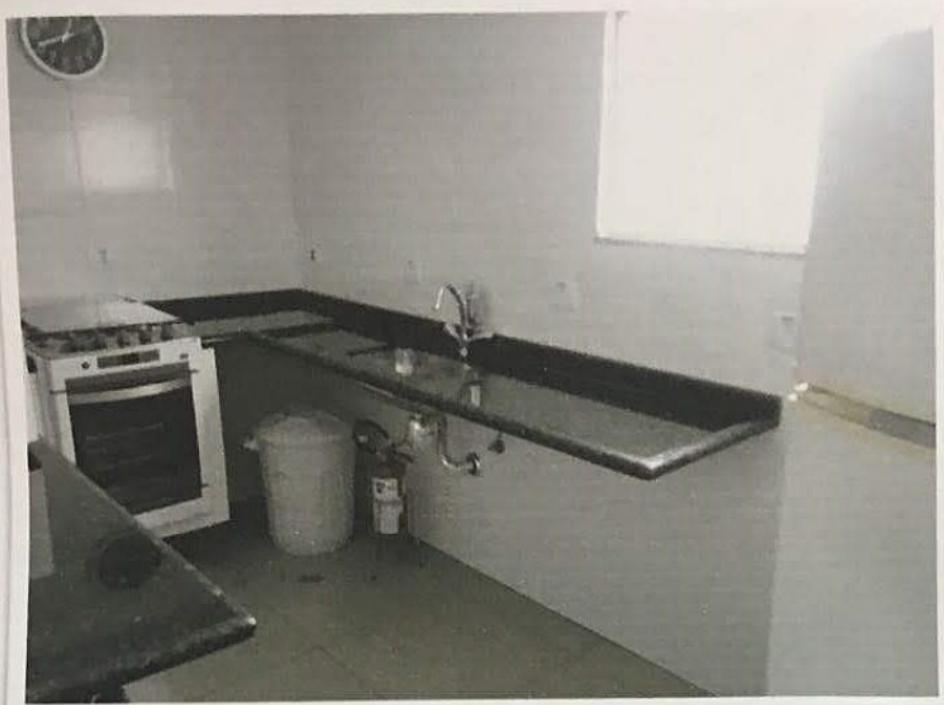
Vista parcial do salão de festas no pavimento térreo do bloco nº 10.
